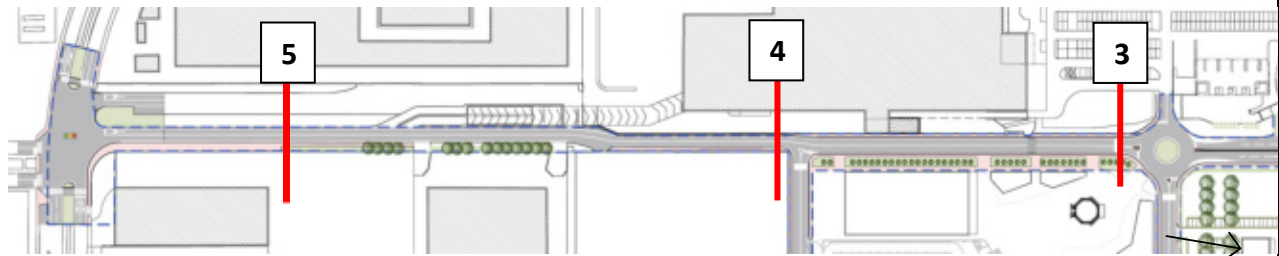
Planimetria intervento di adeguamento viabilità a ovest
